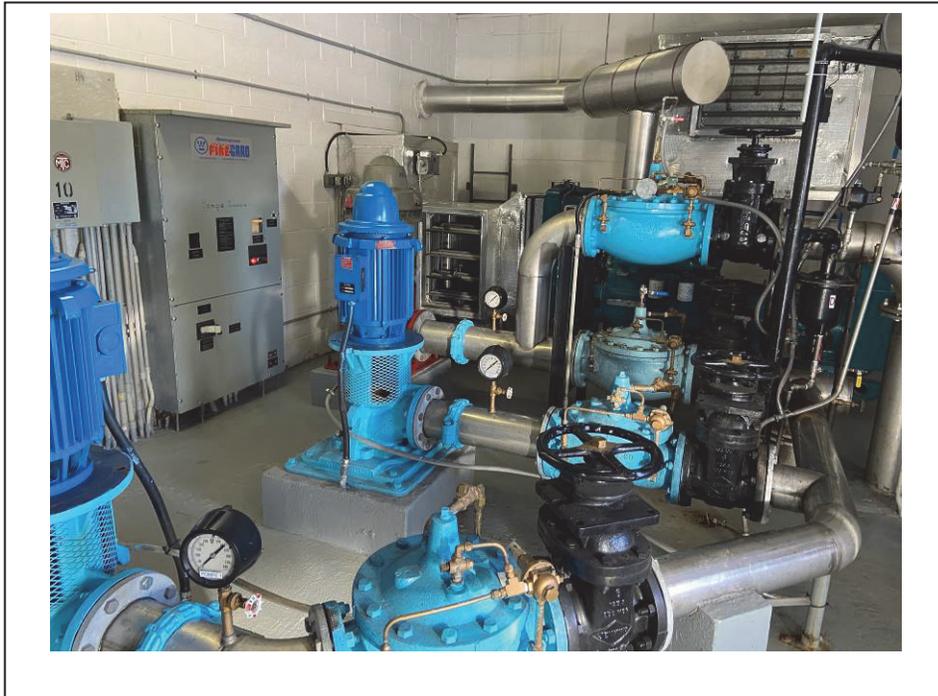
Canalisation et pompe de la station de distribution – 2020-12-18
